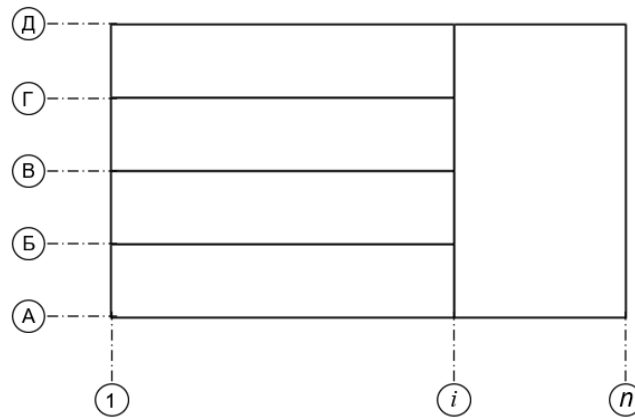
Схематичний план промислової будівлі для 2 варіанту
